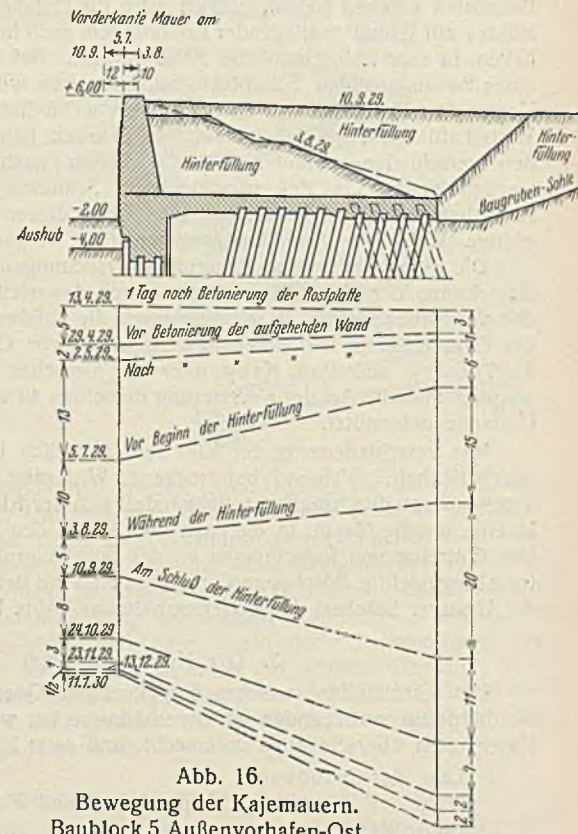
Bewegung der Kajemauern. Baublock 5 Außenvorhafen-Ost.
